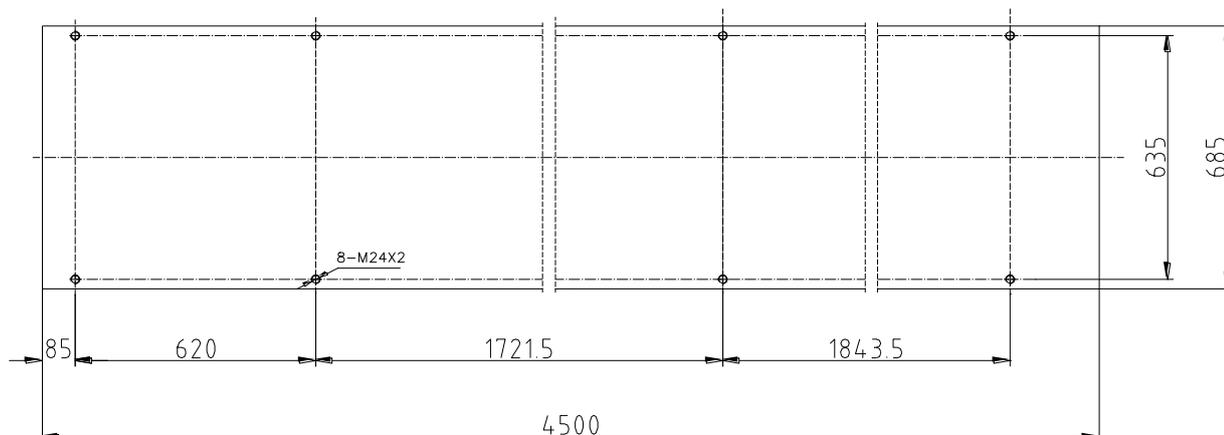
А Чертеж фундамента (для токарного станка 3000 мм)
